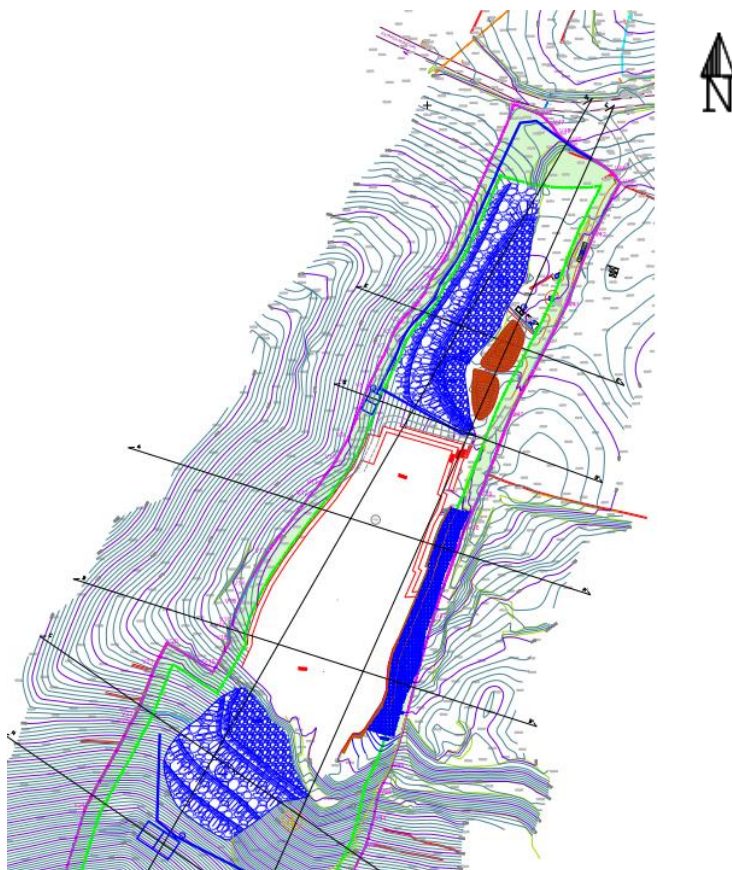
Lavra proposta -Final (s/escala) (ver também planta anexa).
